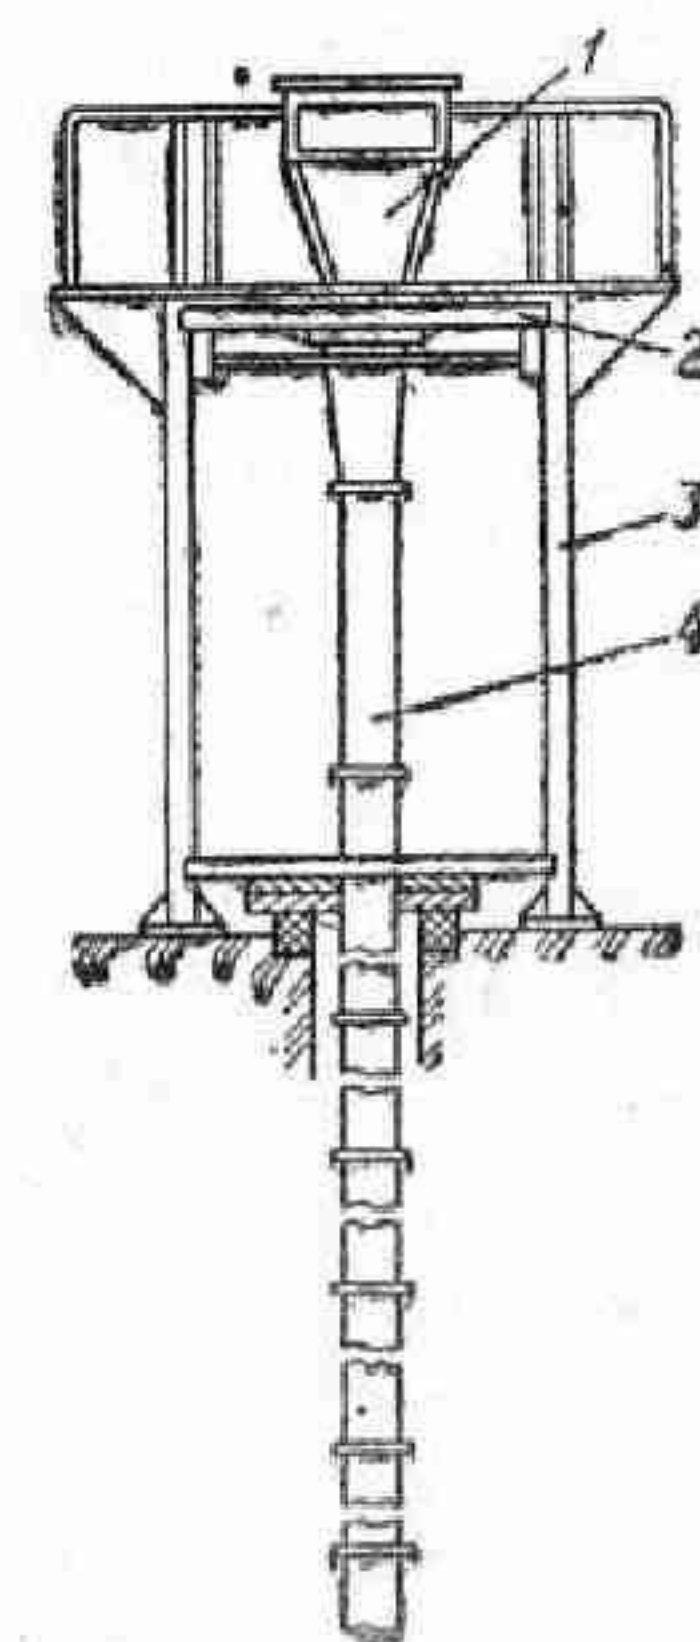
Оборудование для укладки бетона методом ВПТ
